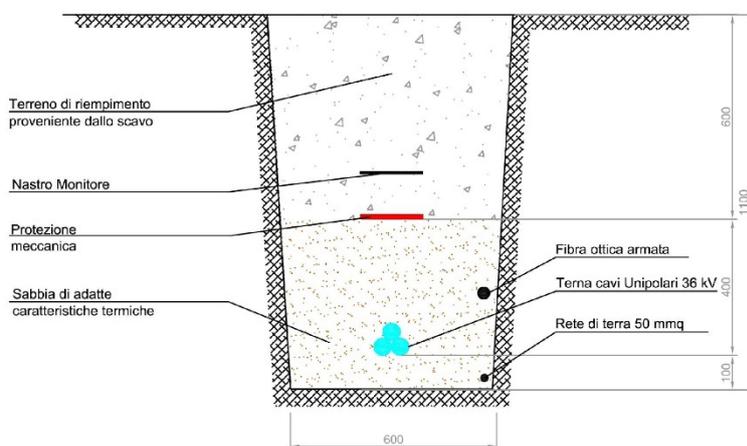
Sezione tipo di scavo su terreno agricolo
